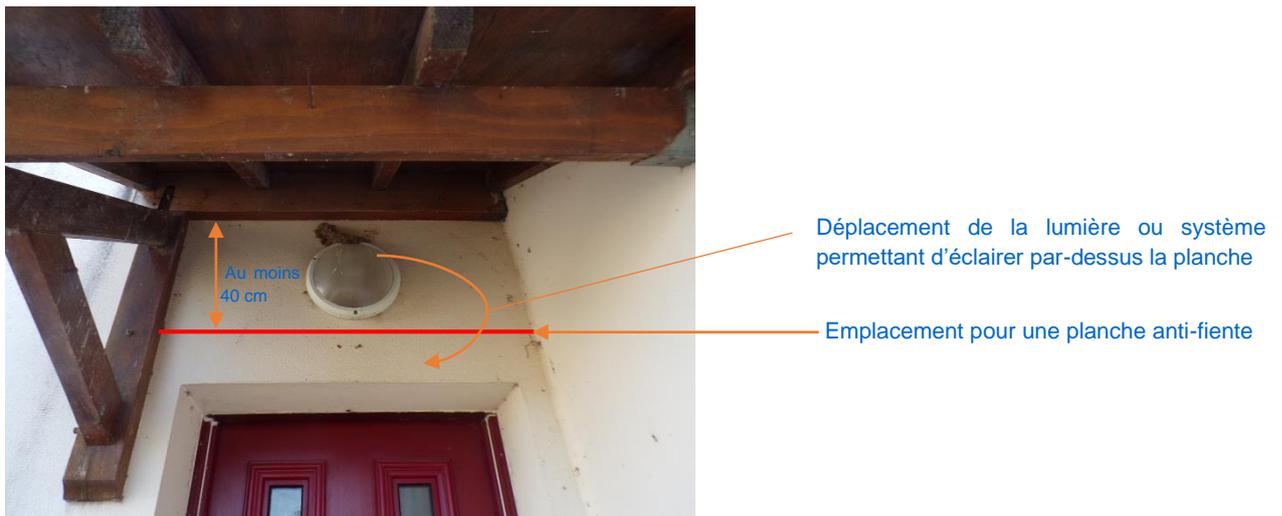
INSTALLATION DE PLANCHES ANTI-FIENTES
